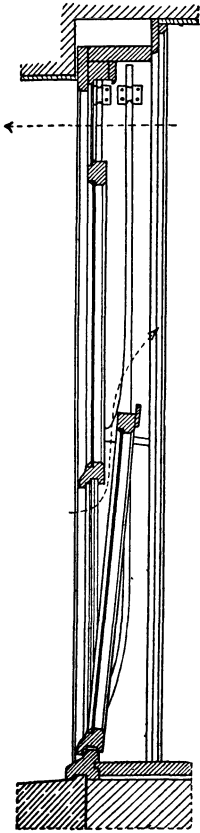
Reform-Schiebefenster z. Lüftung geöffnet.
